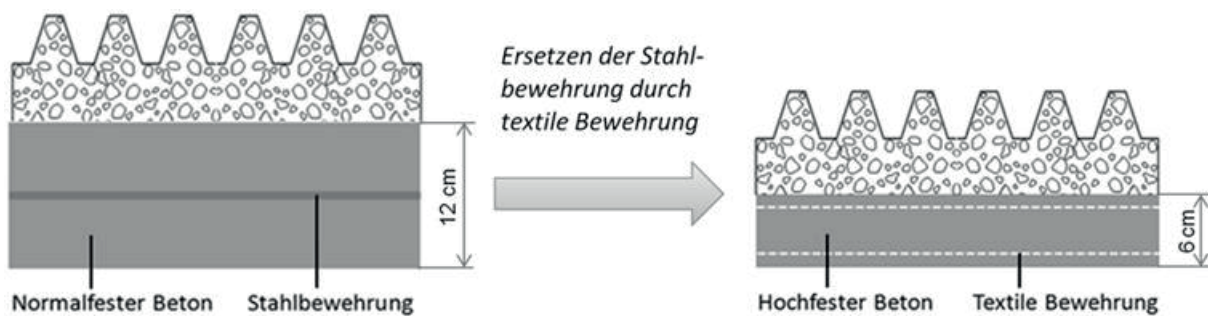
Schematischer Aufbau einer Lärmschutzwand mit Tragplatte aus Stahlbeton (li.) und Textilbeton (re.)
